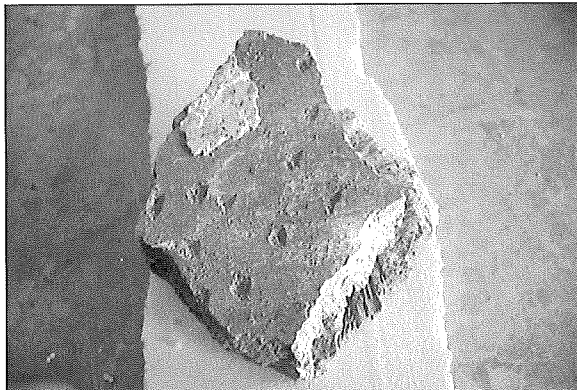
Fragmento de mortero picado de la Fase 2 (A. Cánovas).
